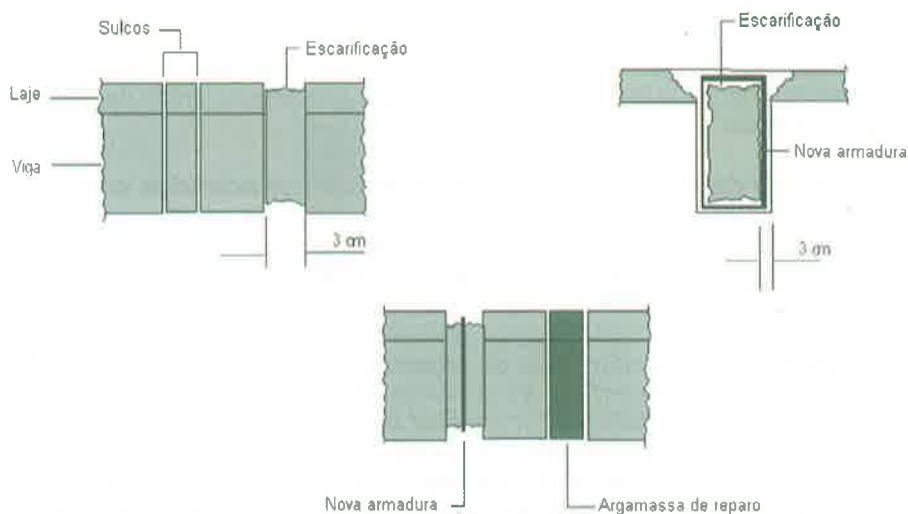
Reforço de cortante em vigas com argamassa epóxi.
